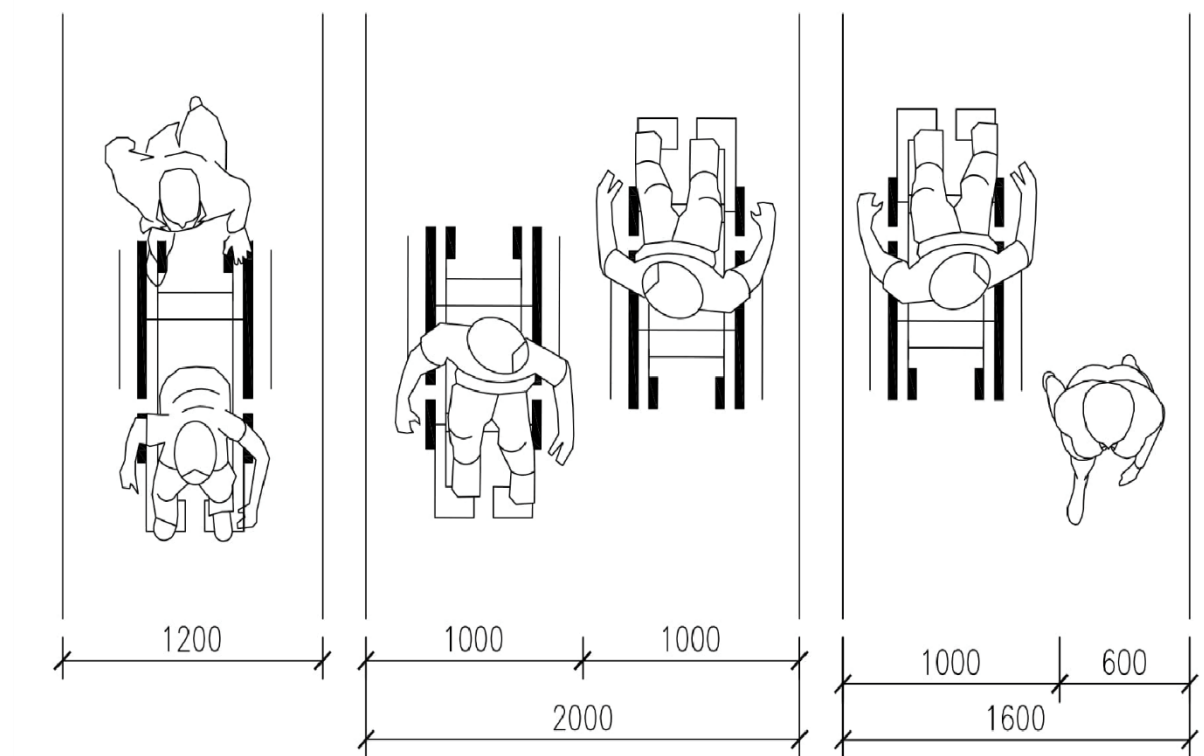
Рекомендовані габарити проходів у громадських будівлях.
